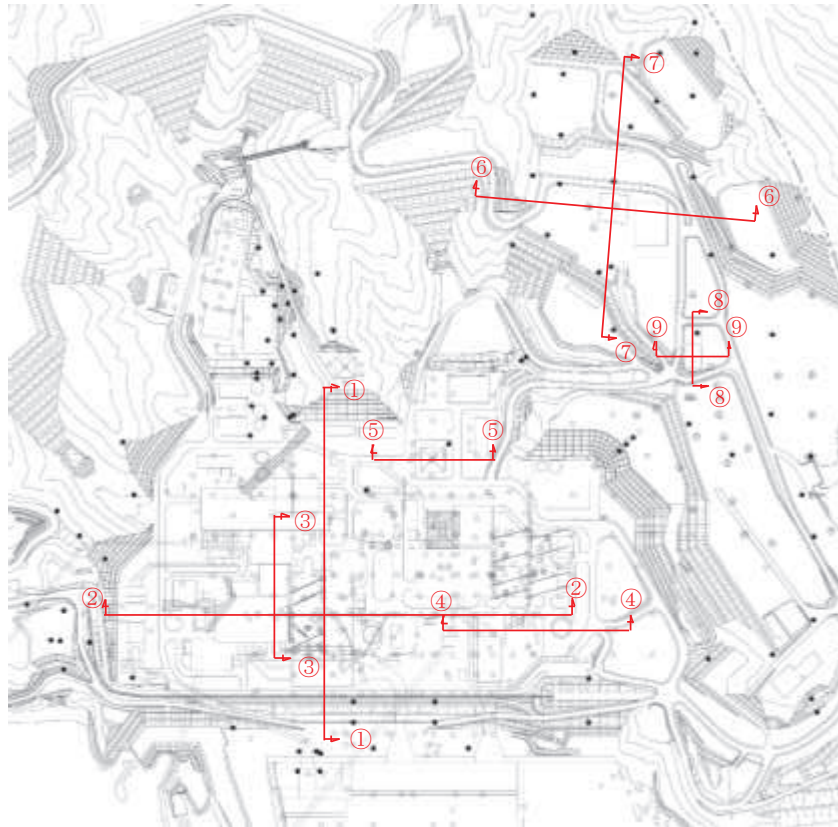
(1) 地質断面图位置 (①—①断面~⑨—⑨断面)
